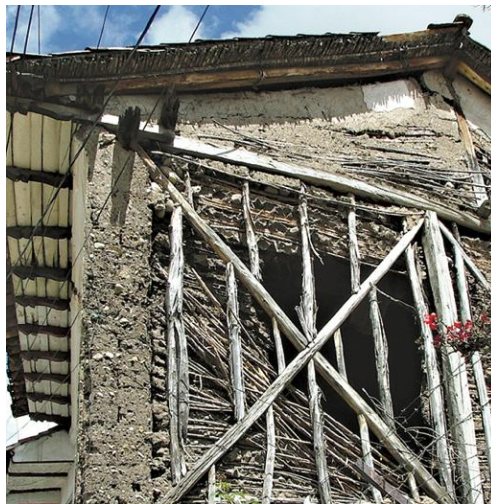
Se puede observar la fachada construida en adobe y los muros interiores en bahareque.
